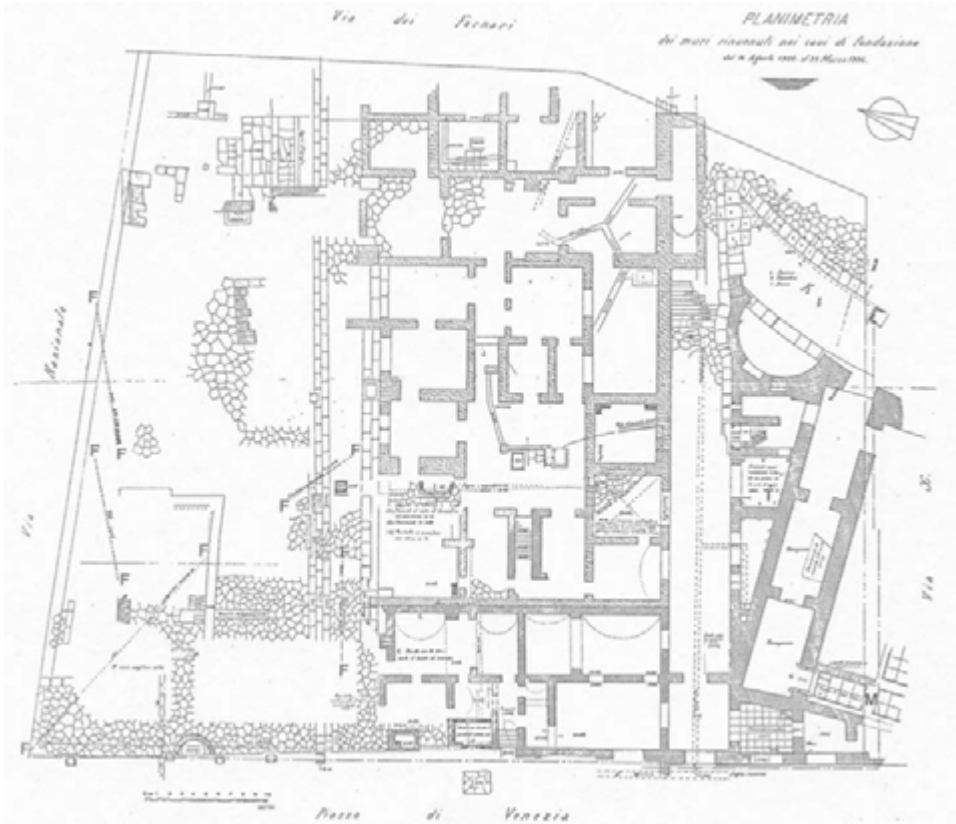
Planimetría de las excavaciones de 1902 bajo el Palazzo Generali.
